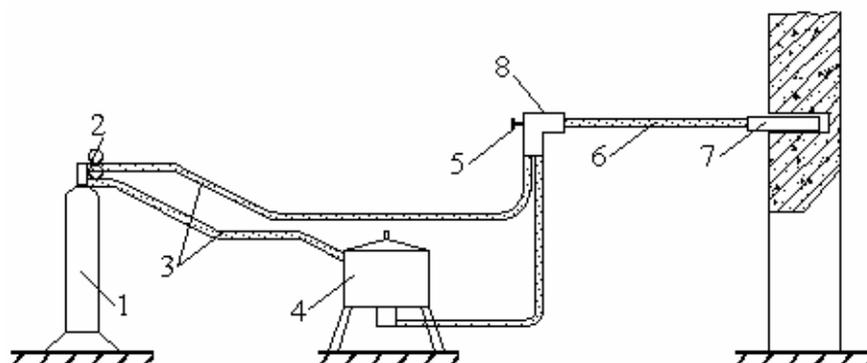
Схема термитно-кислородной установки для резки бетона и железобетона:
